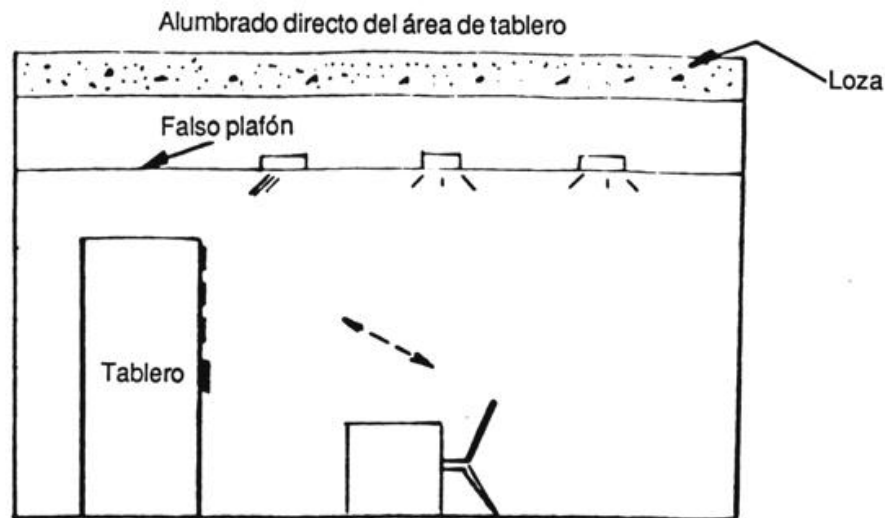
Unidades de embutir o empotrar instaladas en falso plafón plano.
